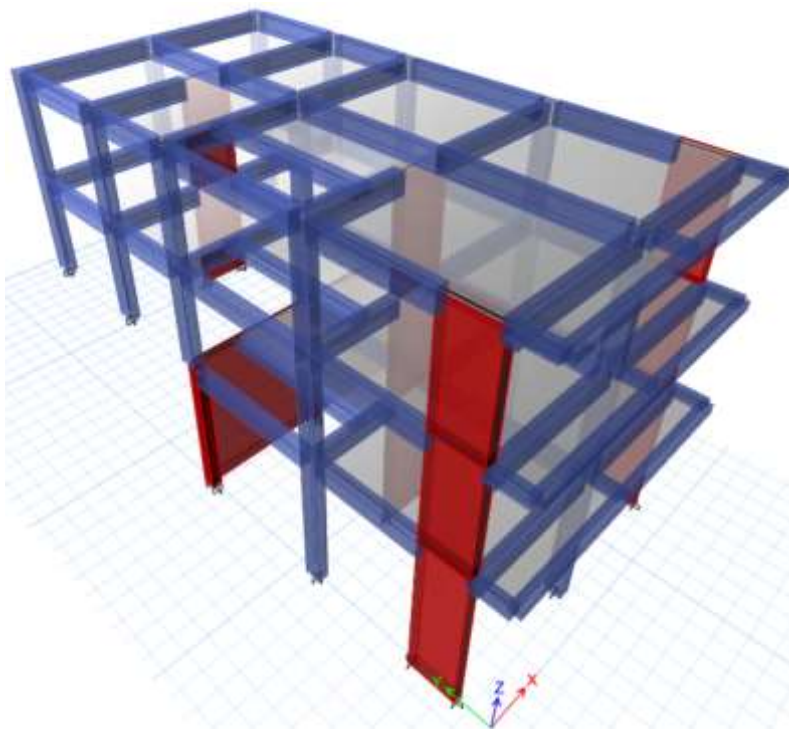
Propuesta de Concreto Armado, modelo 3D para el análisis
